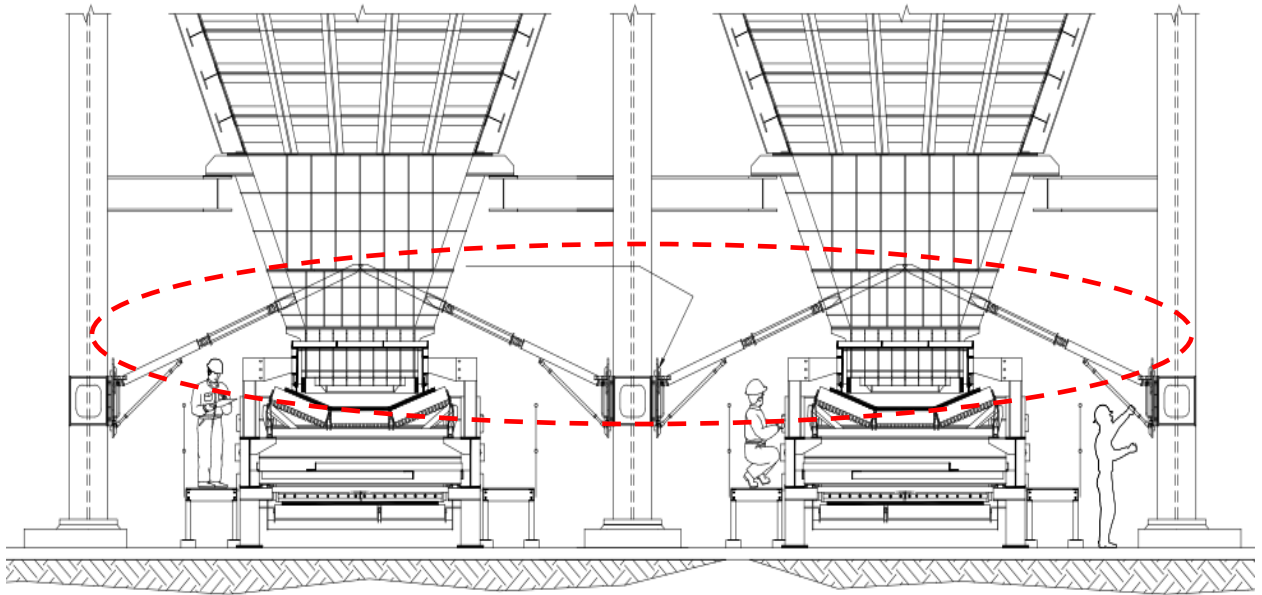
Sistema de Retención de Carga tipo Válvula de Lanzas.
